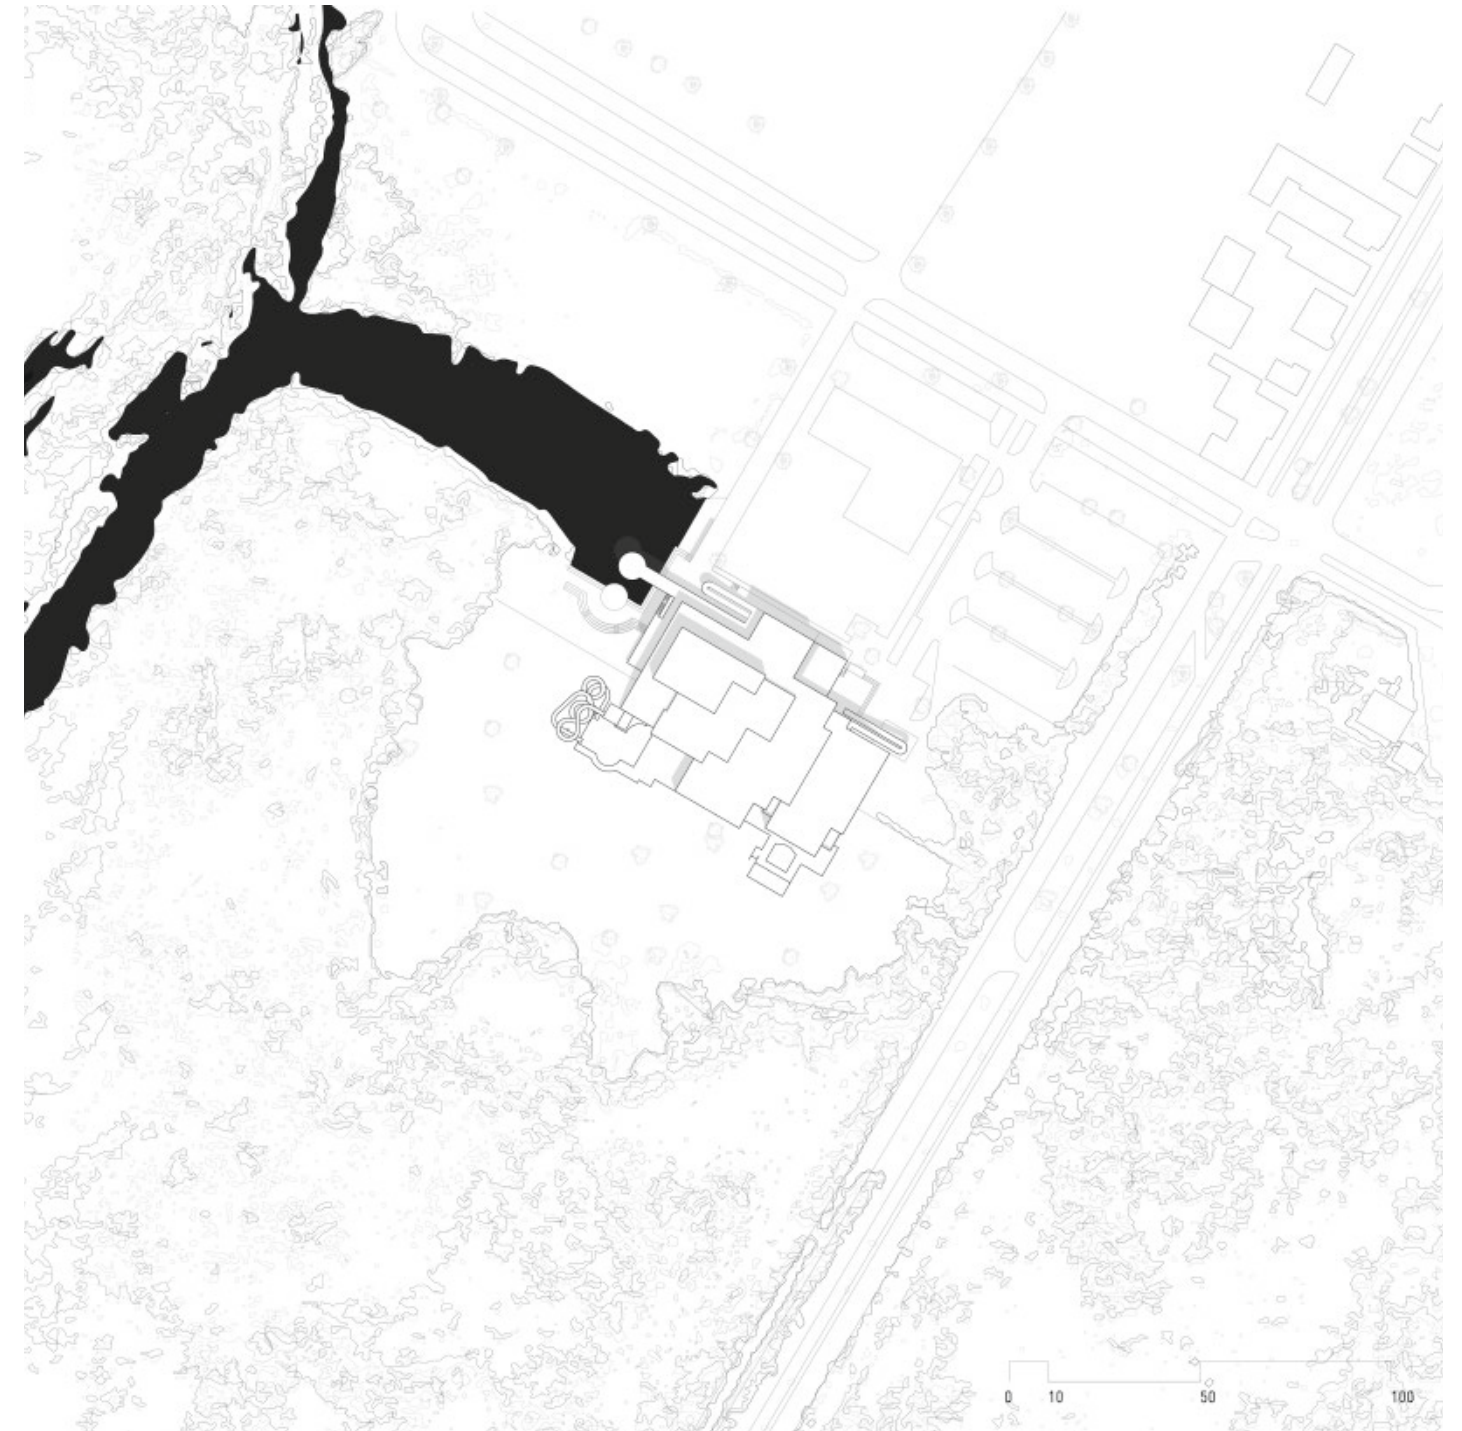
Lageplan, Gebauter Zustand inkl aller Umbauten
